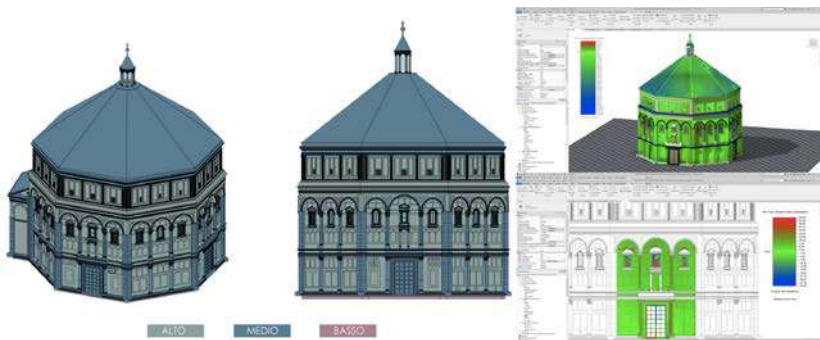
Rappresentazione tematica dei LOR a seconda del livello di affidabilità oggettiva dei singoli elementi modellati. A destra, il processo di validazione generale e di dettaglio del modello BIM all'interno del plug-in Revit Point Layout (elaborazione grafica dell'autrice).
